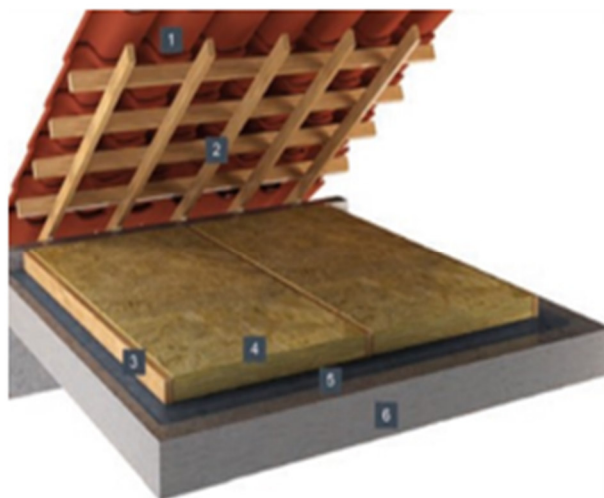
Exemplo Imperialum - Cobertura inclinada (isolante sobre esteira horizontal)
